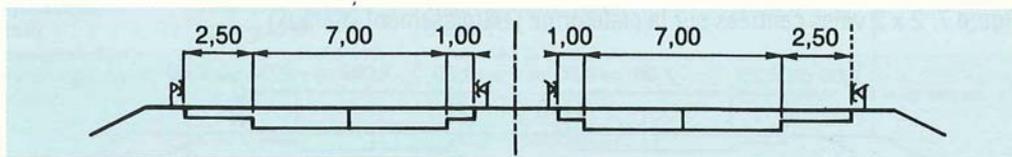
une chaussée de 7,00 m sur plateforme définitive
